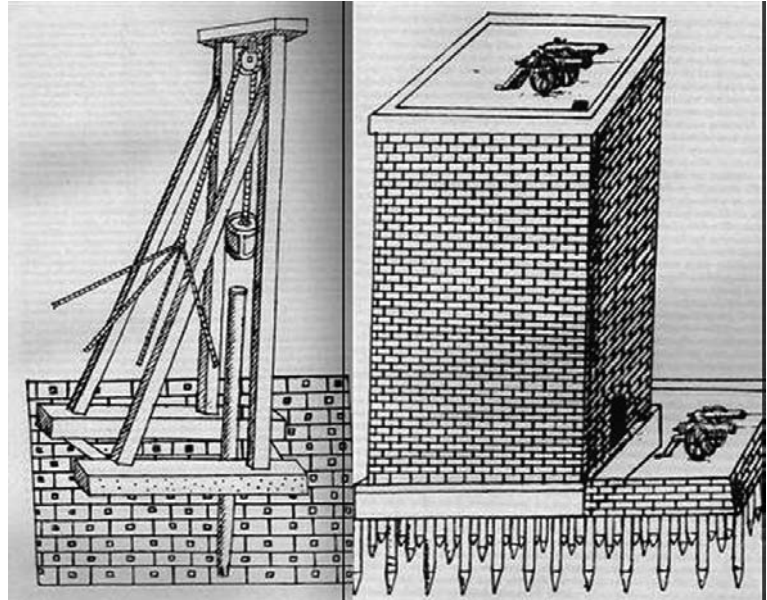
Máquina de hincar pilotes con planta de sillares agujereados (izqda.). Fortificación ya terminada sobre cimentación de pilotes (dcha.). Cristobal de Rojas (1607).
